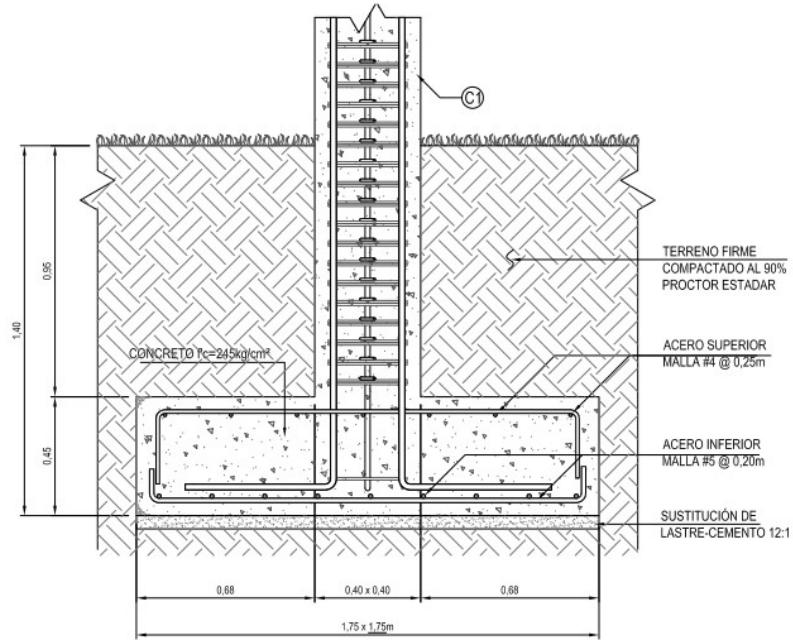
Planta estructural de cimentaciones - DICE, 2017.
